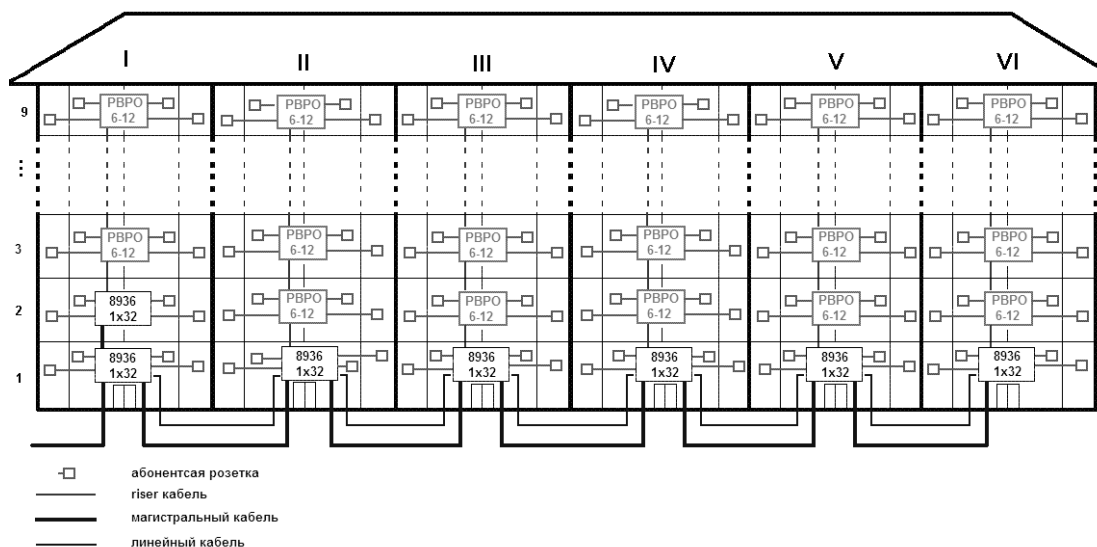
Схема с узлами распределения в каждом подъезде со шкафами 8936 на первых этажах здания
